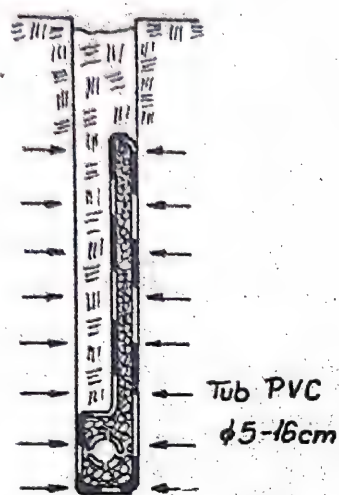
Dren cu prefabricat geotextil drenant
